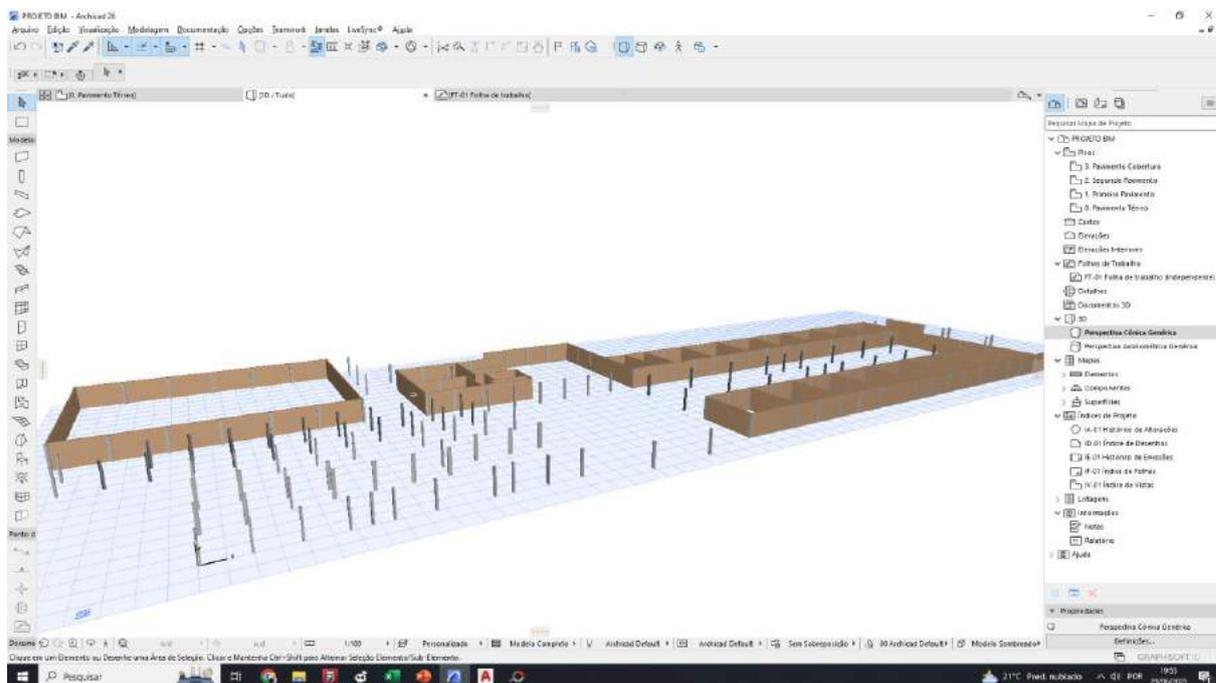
Projeto estrutural em ArchiCAD para o projeto 2 (etapa 1).
